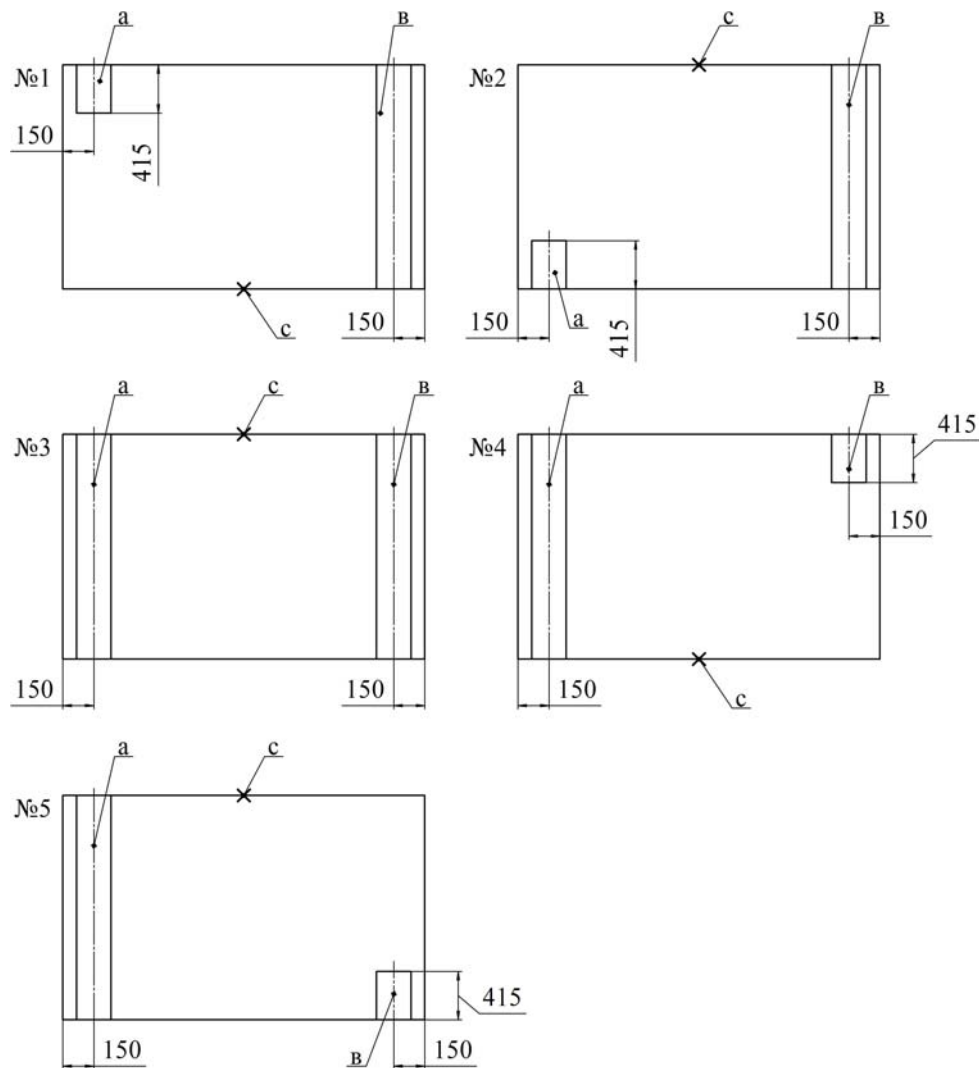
Схемы нагружения перекрытия секции МКЮ.2ПШ-26/53
